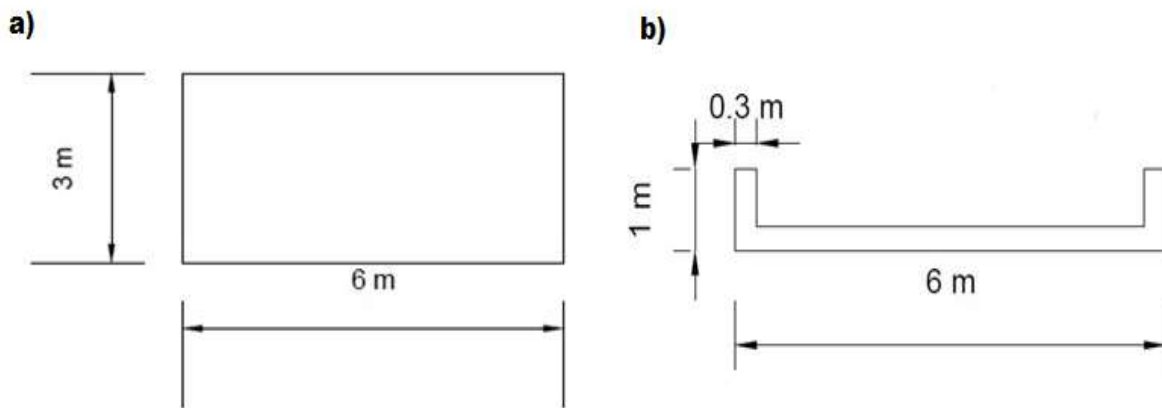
Diseño del muro de adobe a escala real: a) vista frontal; b) vista en planta.
